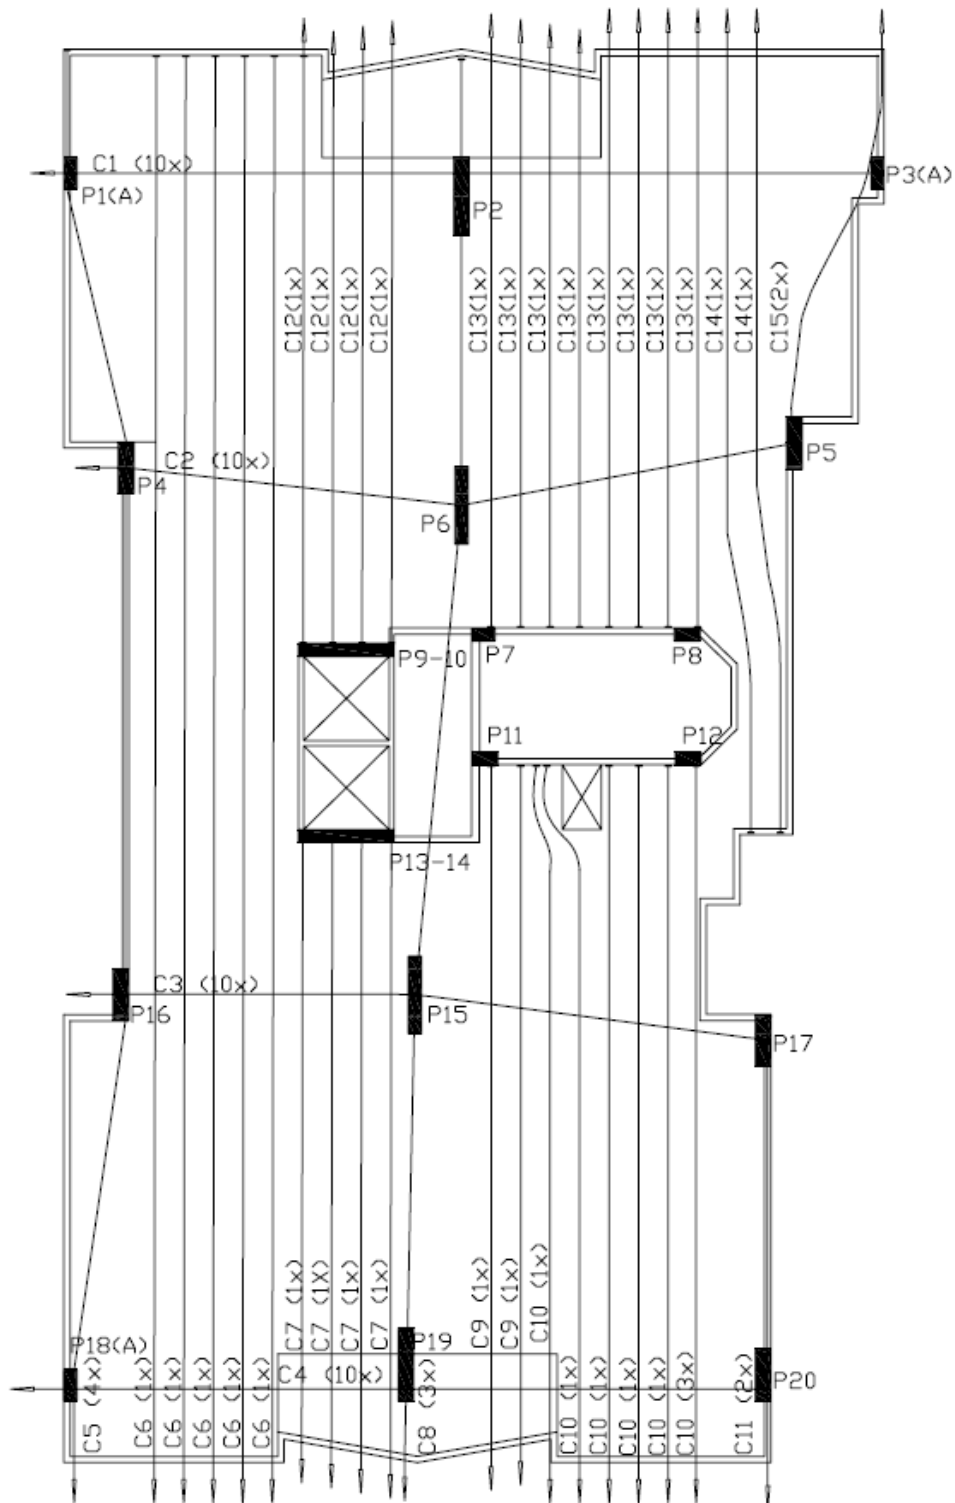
Forma dos cabos de protensão da laje dos pavimentos tipo
